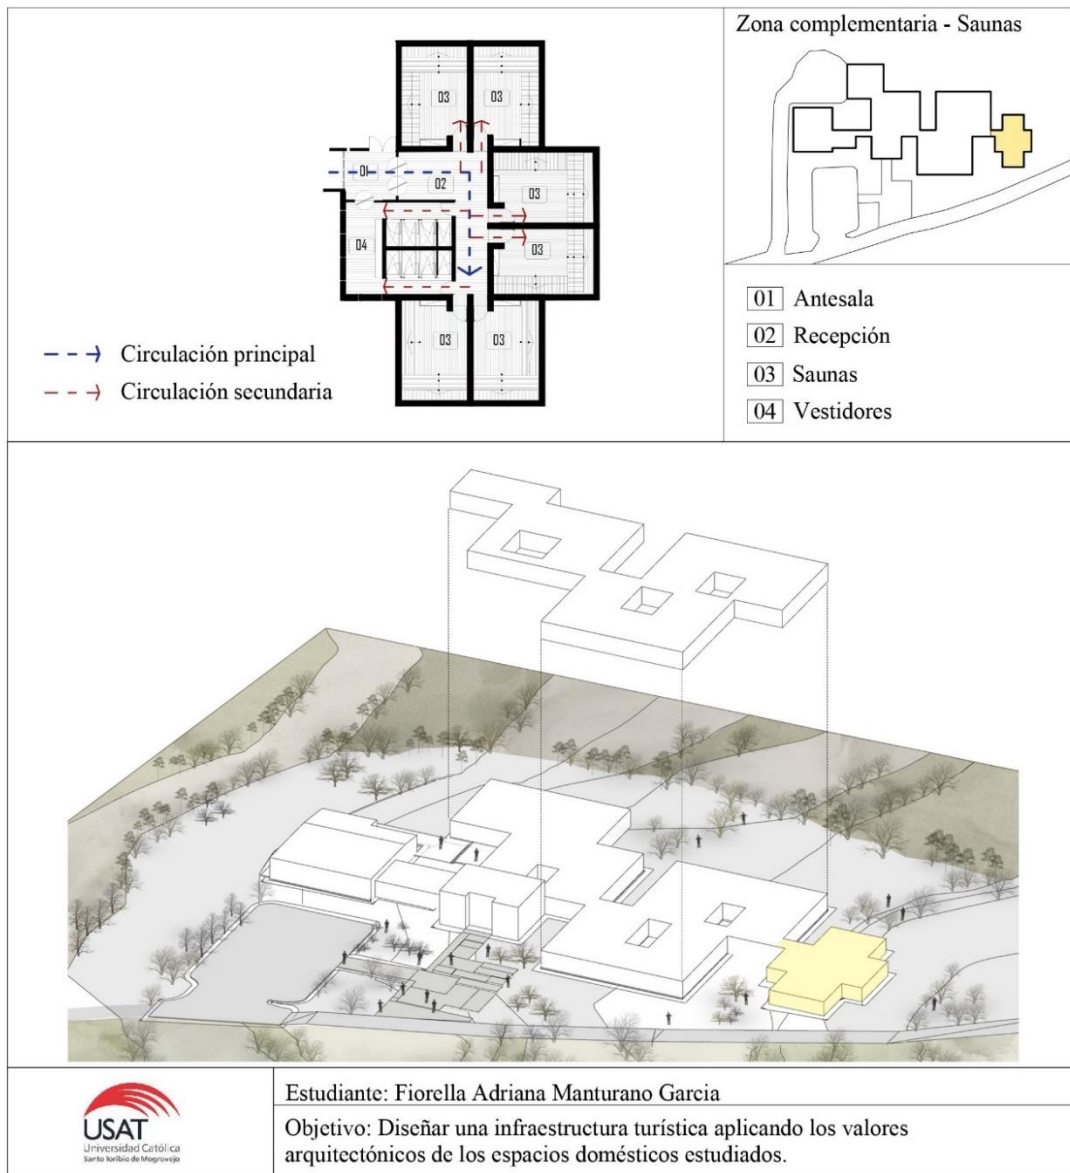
Zona Complementaria Sauna Plano / Axonometría(Primer Nivel) .
